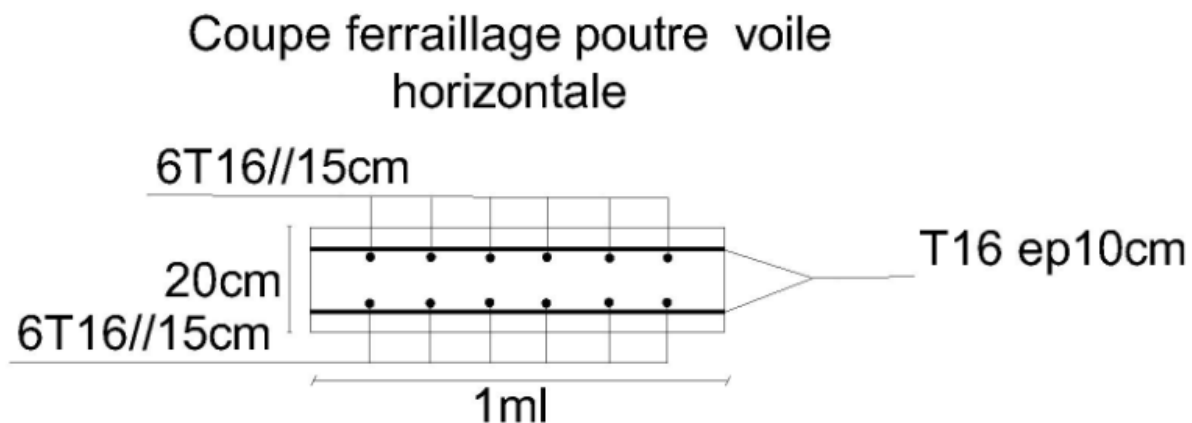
Coupe ferrailage poutre voile horizontale
